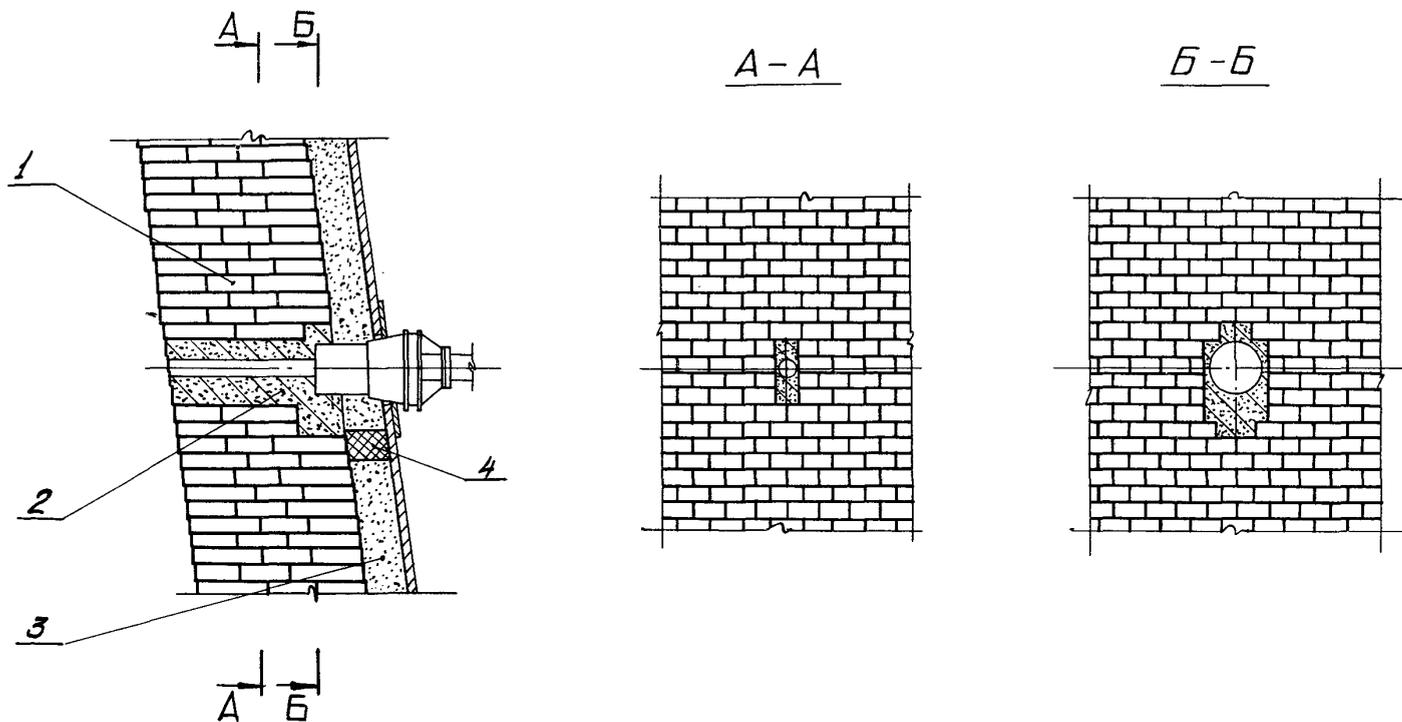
Кладка отверстий в шахте для установки машины для отбора проб газа:
